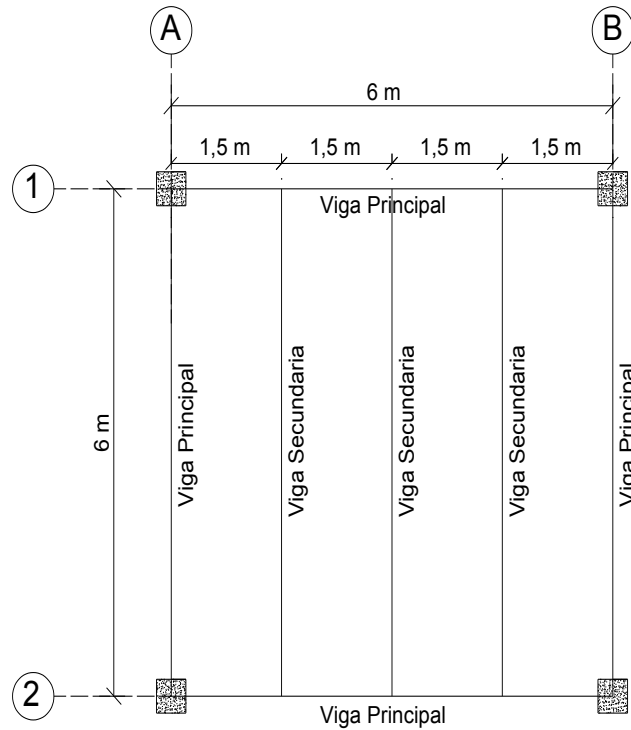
Detalle de la colocación de las vigas secundarias.
